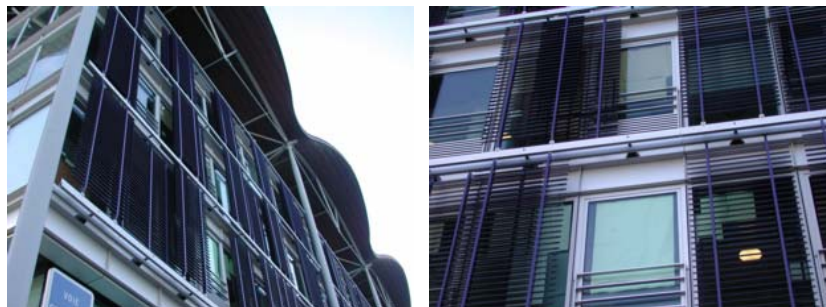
Façade Ouest, détails des pare-soleil coulissants
